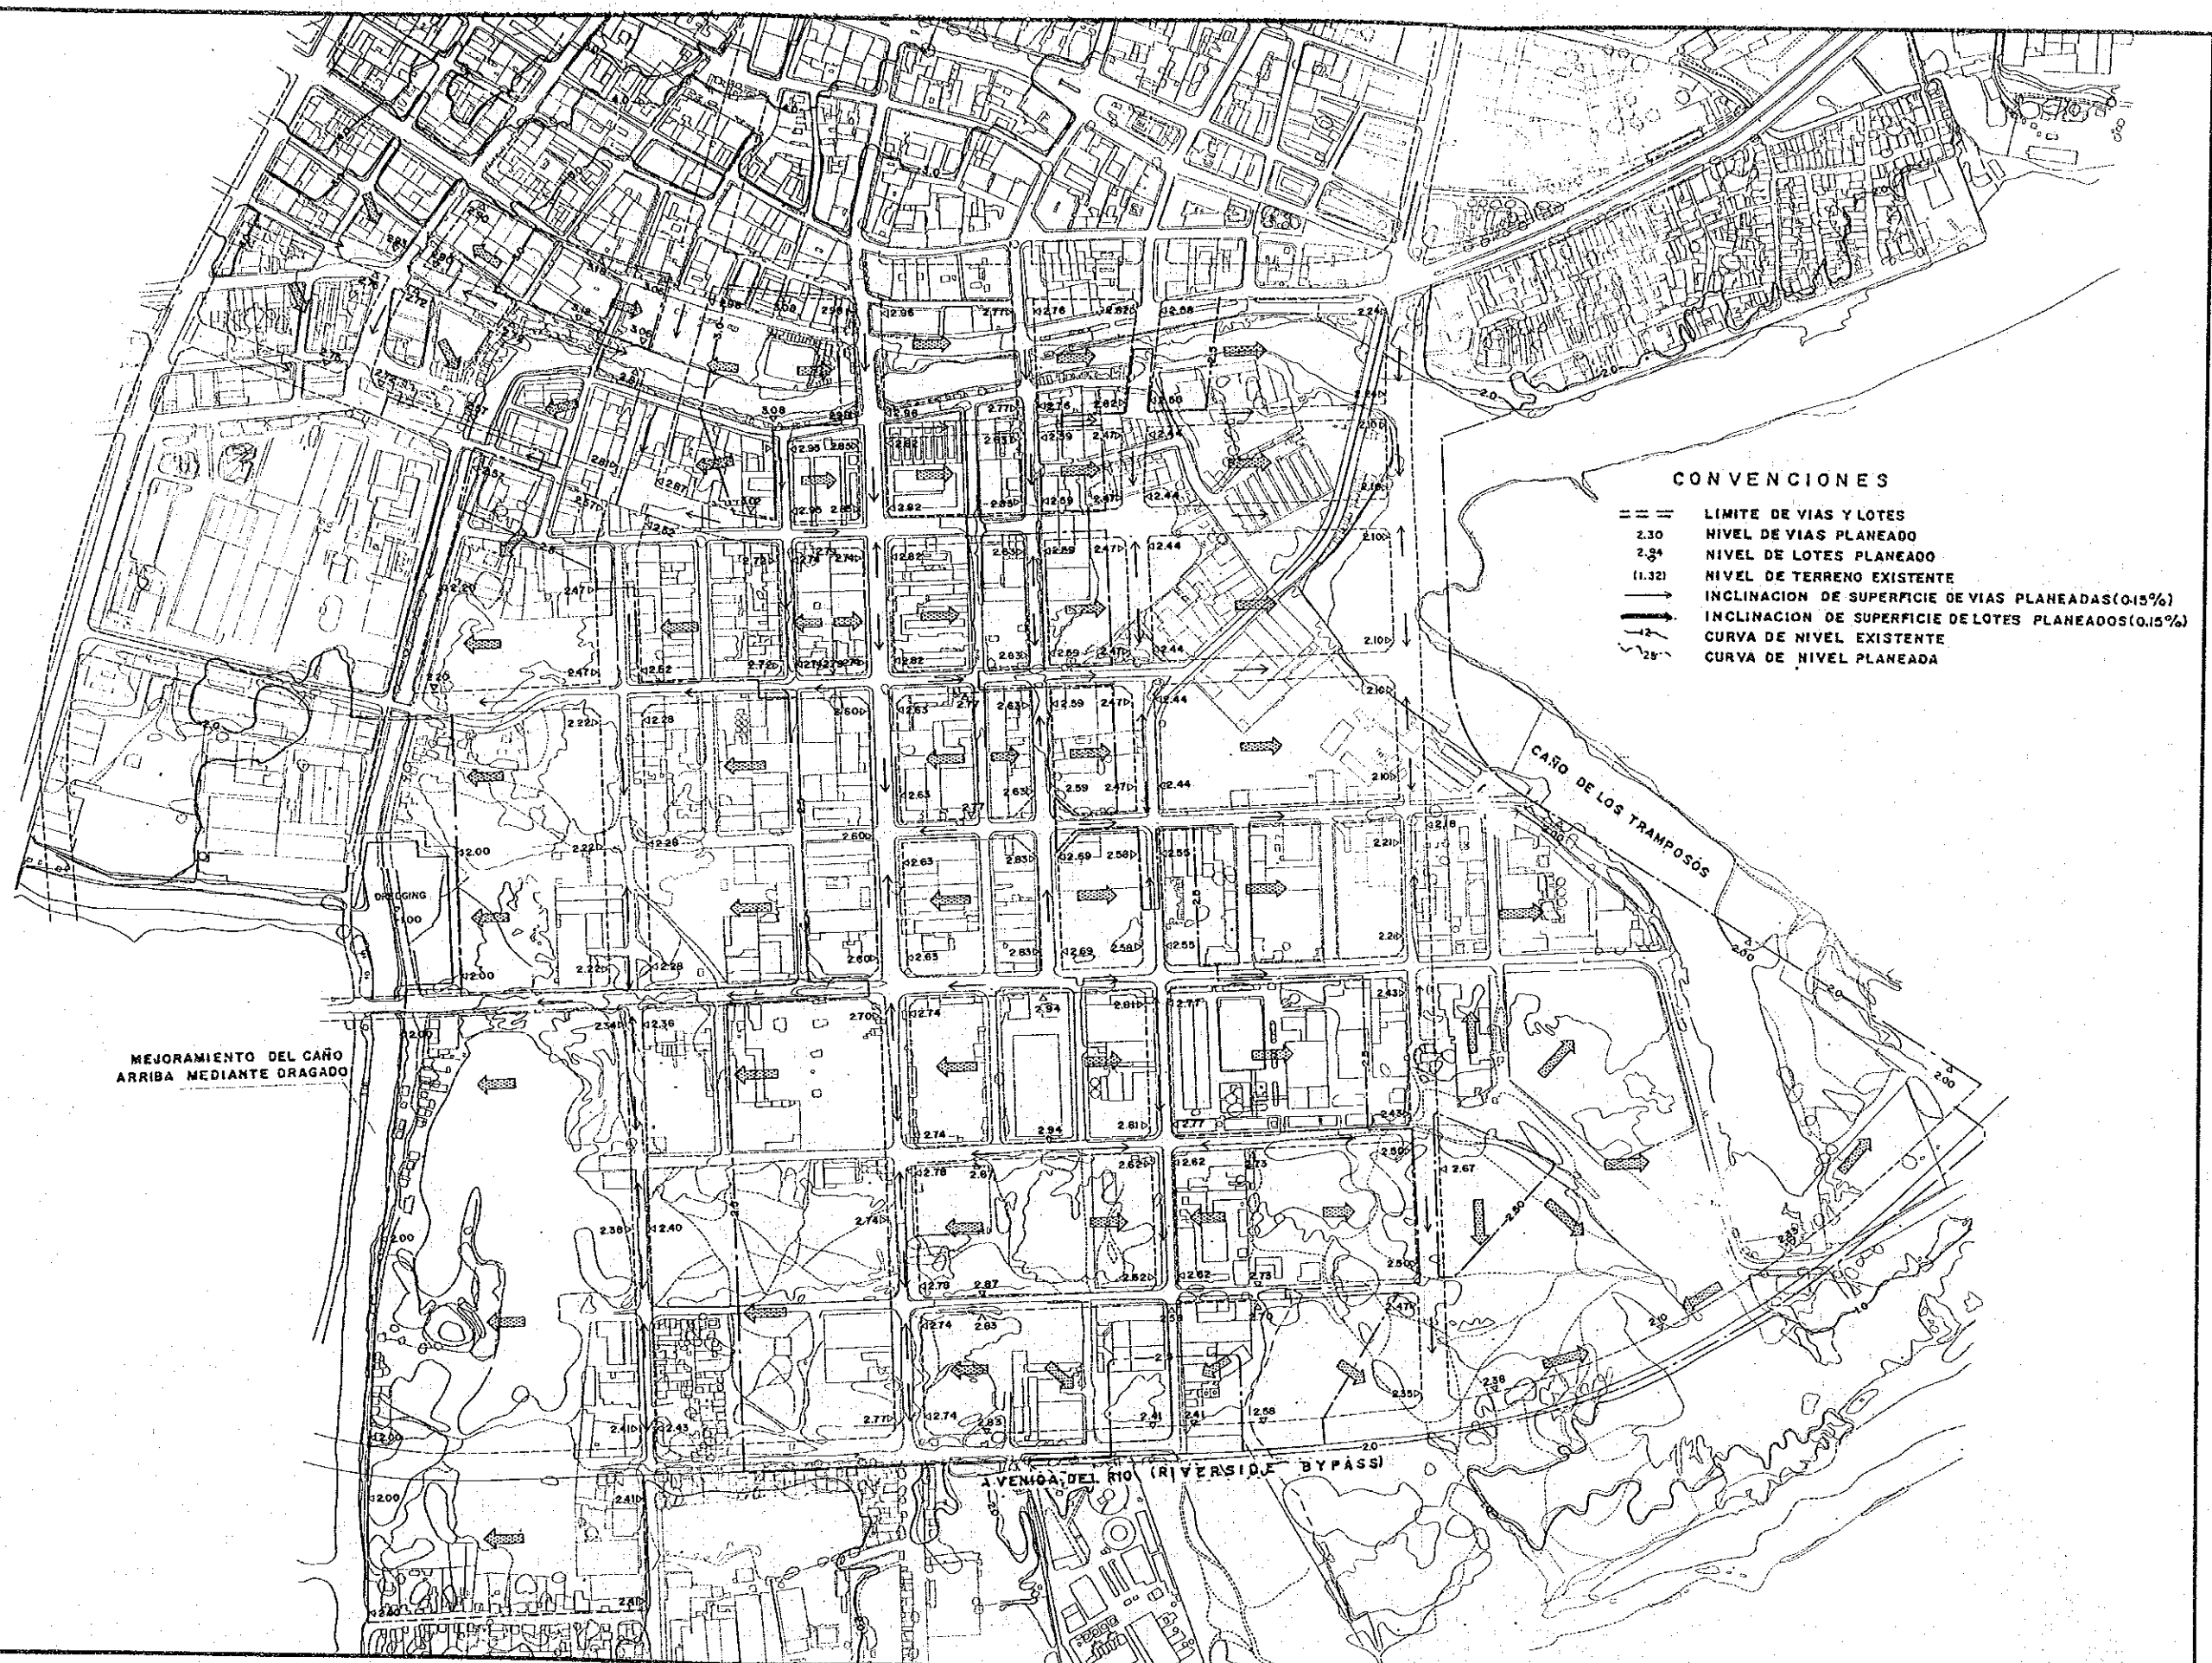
PLANO DE PREPARACION DEL TERRENO
